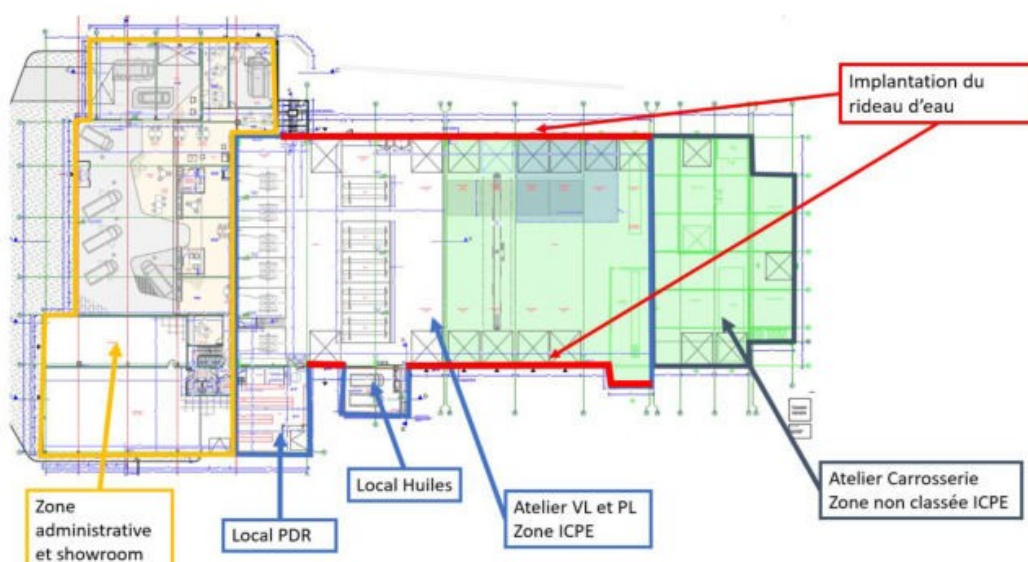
Implantation de rideau d'eau sur les deux façades Est et Ouest du site (source PAC déposé le 27 mai 2024)
